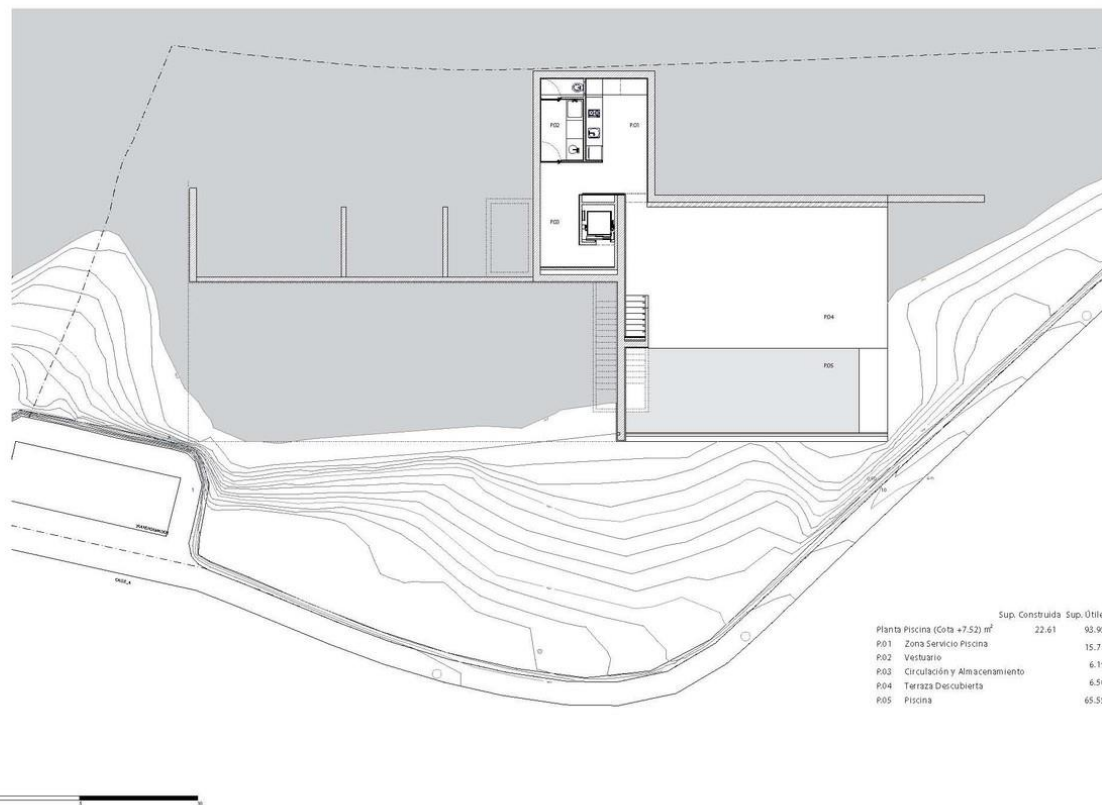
Plano planta piscina (Cota +7.52m). Fuente: Fran Silvestre Arquitectos.
